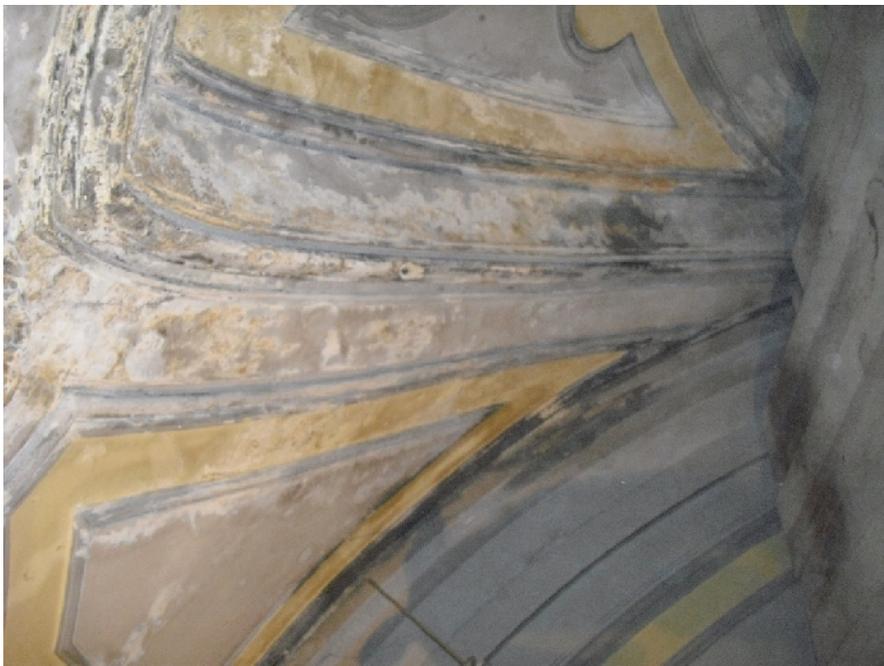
Foggia Cattedrale, situazione stucchi pre restauro (2009).
